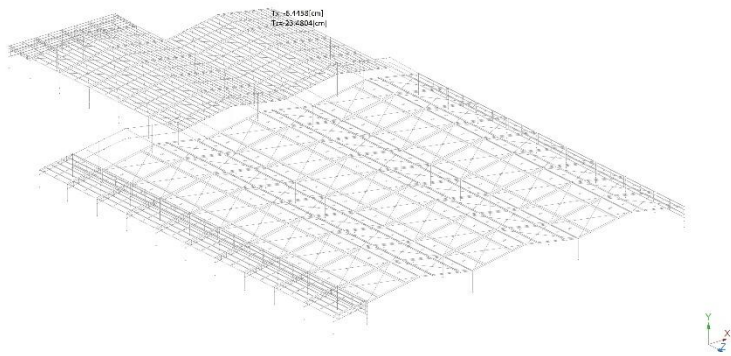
Desplazamientos Verticales Actuales en Estructura Nave 3
